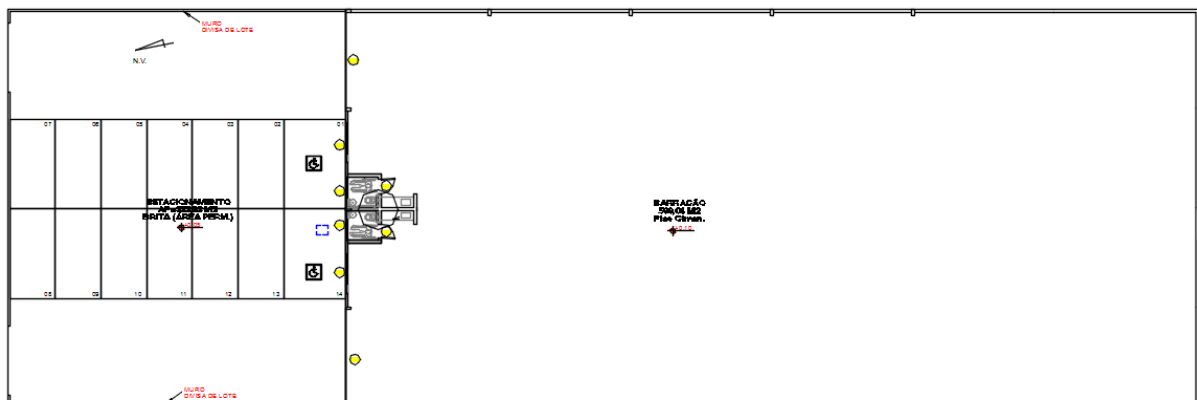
Galpões Industriais Executados em Alvenaria Estrutural – Obra 7 e 8.
